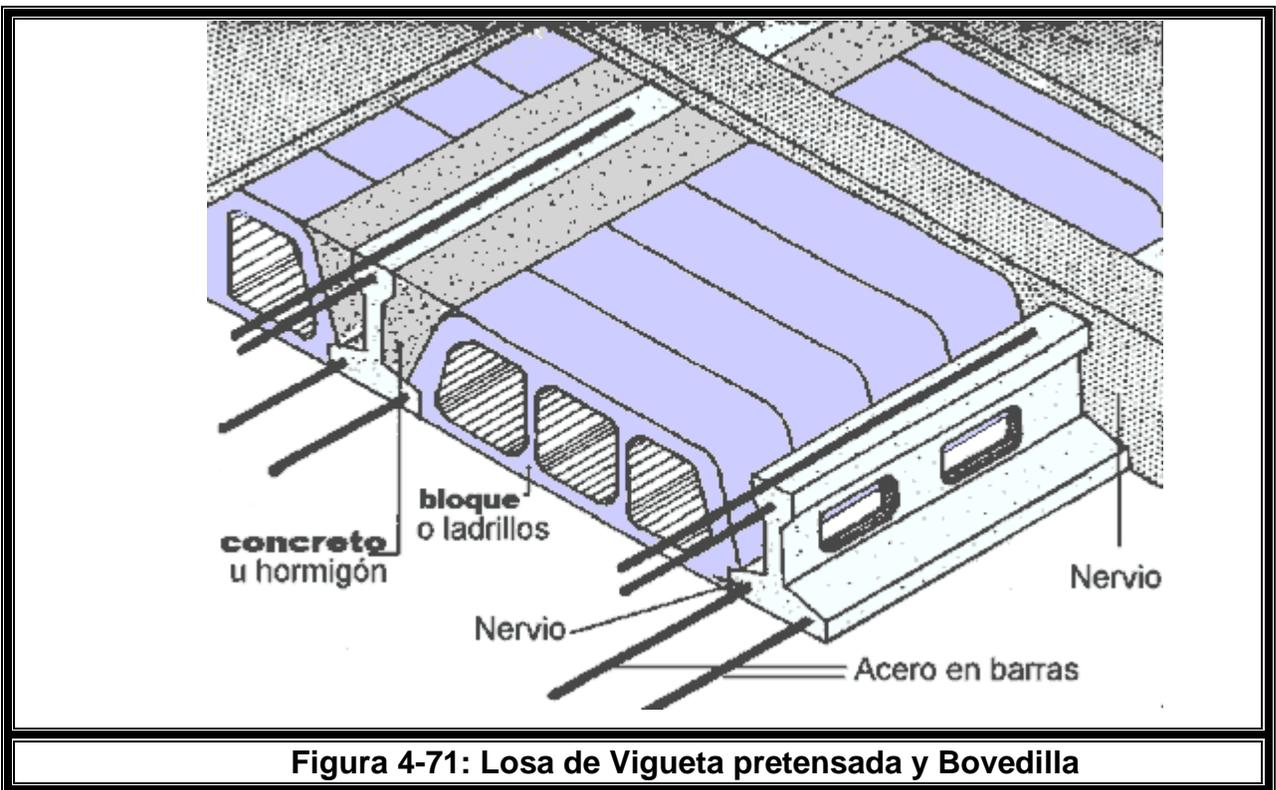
Losa de Vigueta pretensada y Bovedilla
